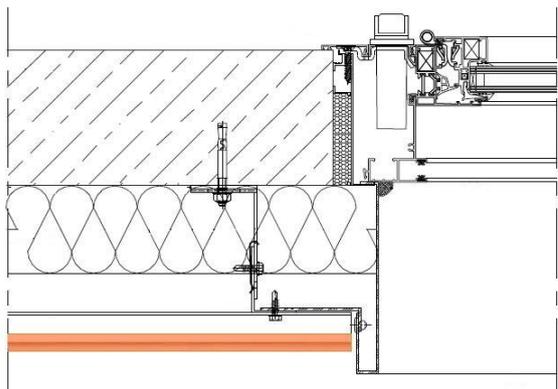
Jamba con pieza metálica. FAVEKER® FV. Sistema perfil horizontal.
